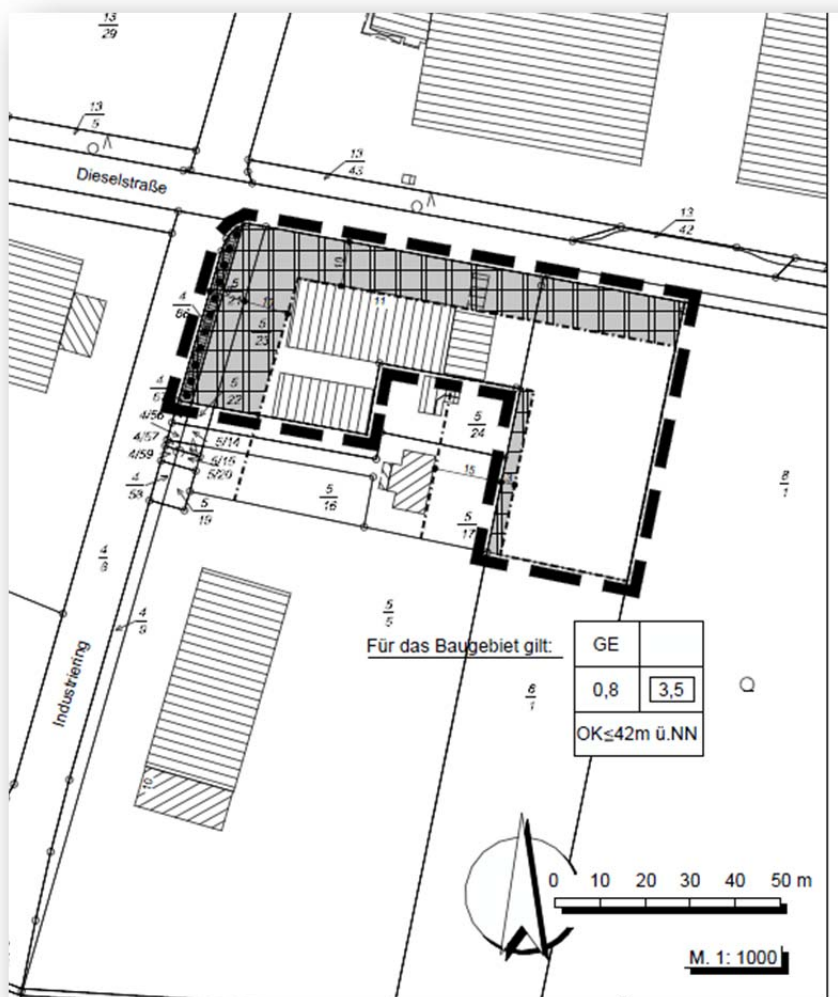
Plangebiet (von Strichellinie umgrenzter Bereich), pk plankontor städtebau
